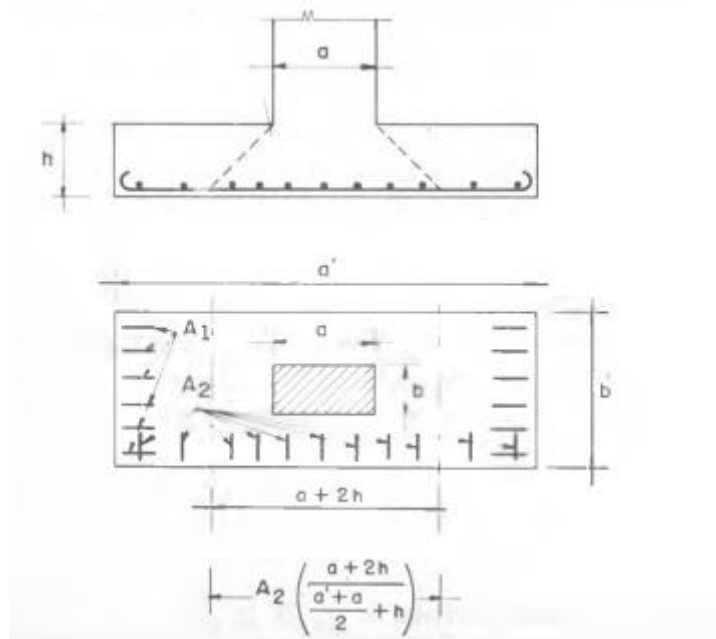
Distribuição das armaduras em sapatas retangulares.
